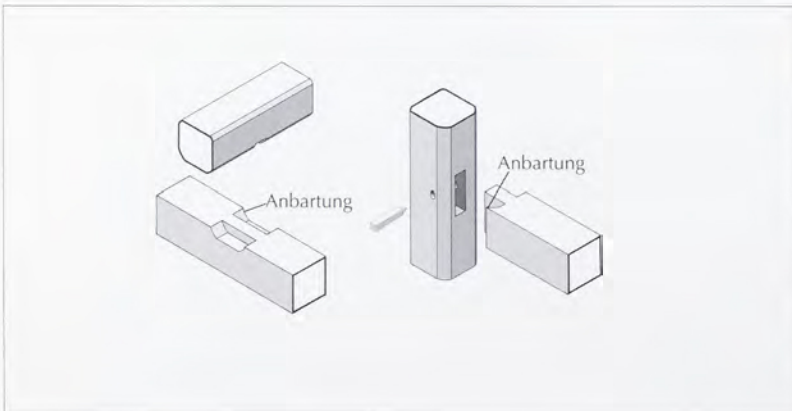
Gegenholz mit Zapfenloch und Anschlussholz mit Zapfen.
